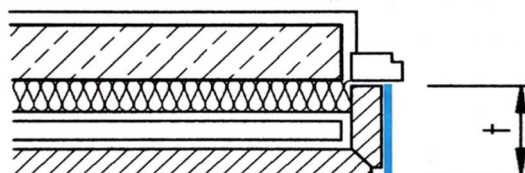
Coupe horizontale sur façade ; ébrasement de fenêtre
